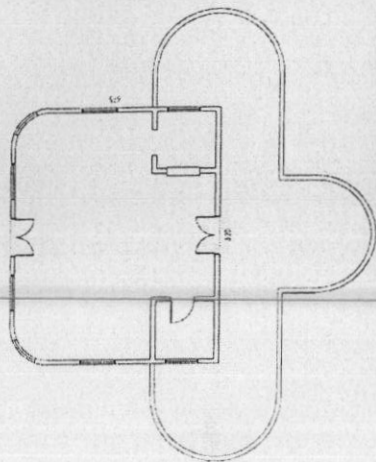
Croqui da planta baixa da Xerox do CCA- Campus II
